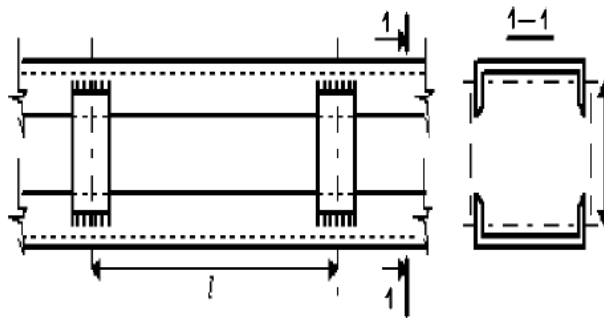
Конструктивна схема наскрізного перерізу на планках [2]
